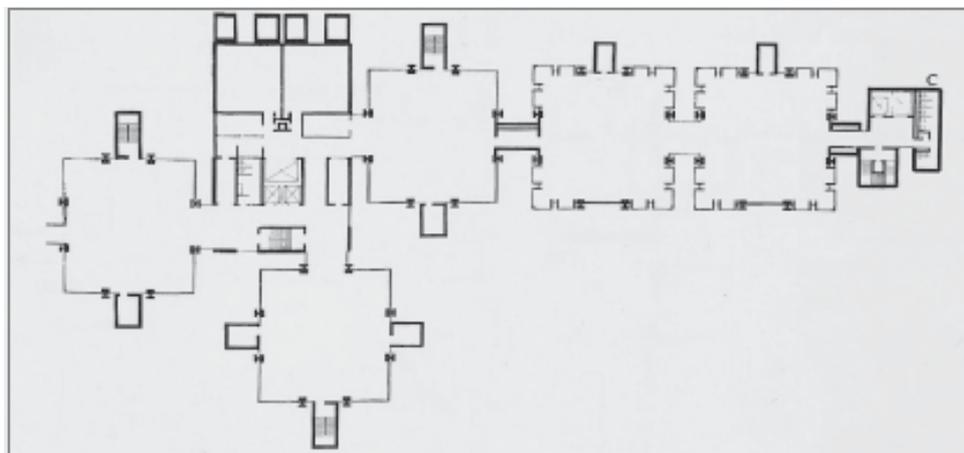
Planta do pavimento tipo do Richards Medical Research Building and Biology Building, 1957- 65.
